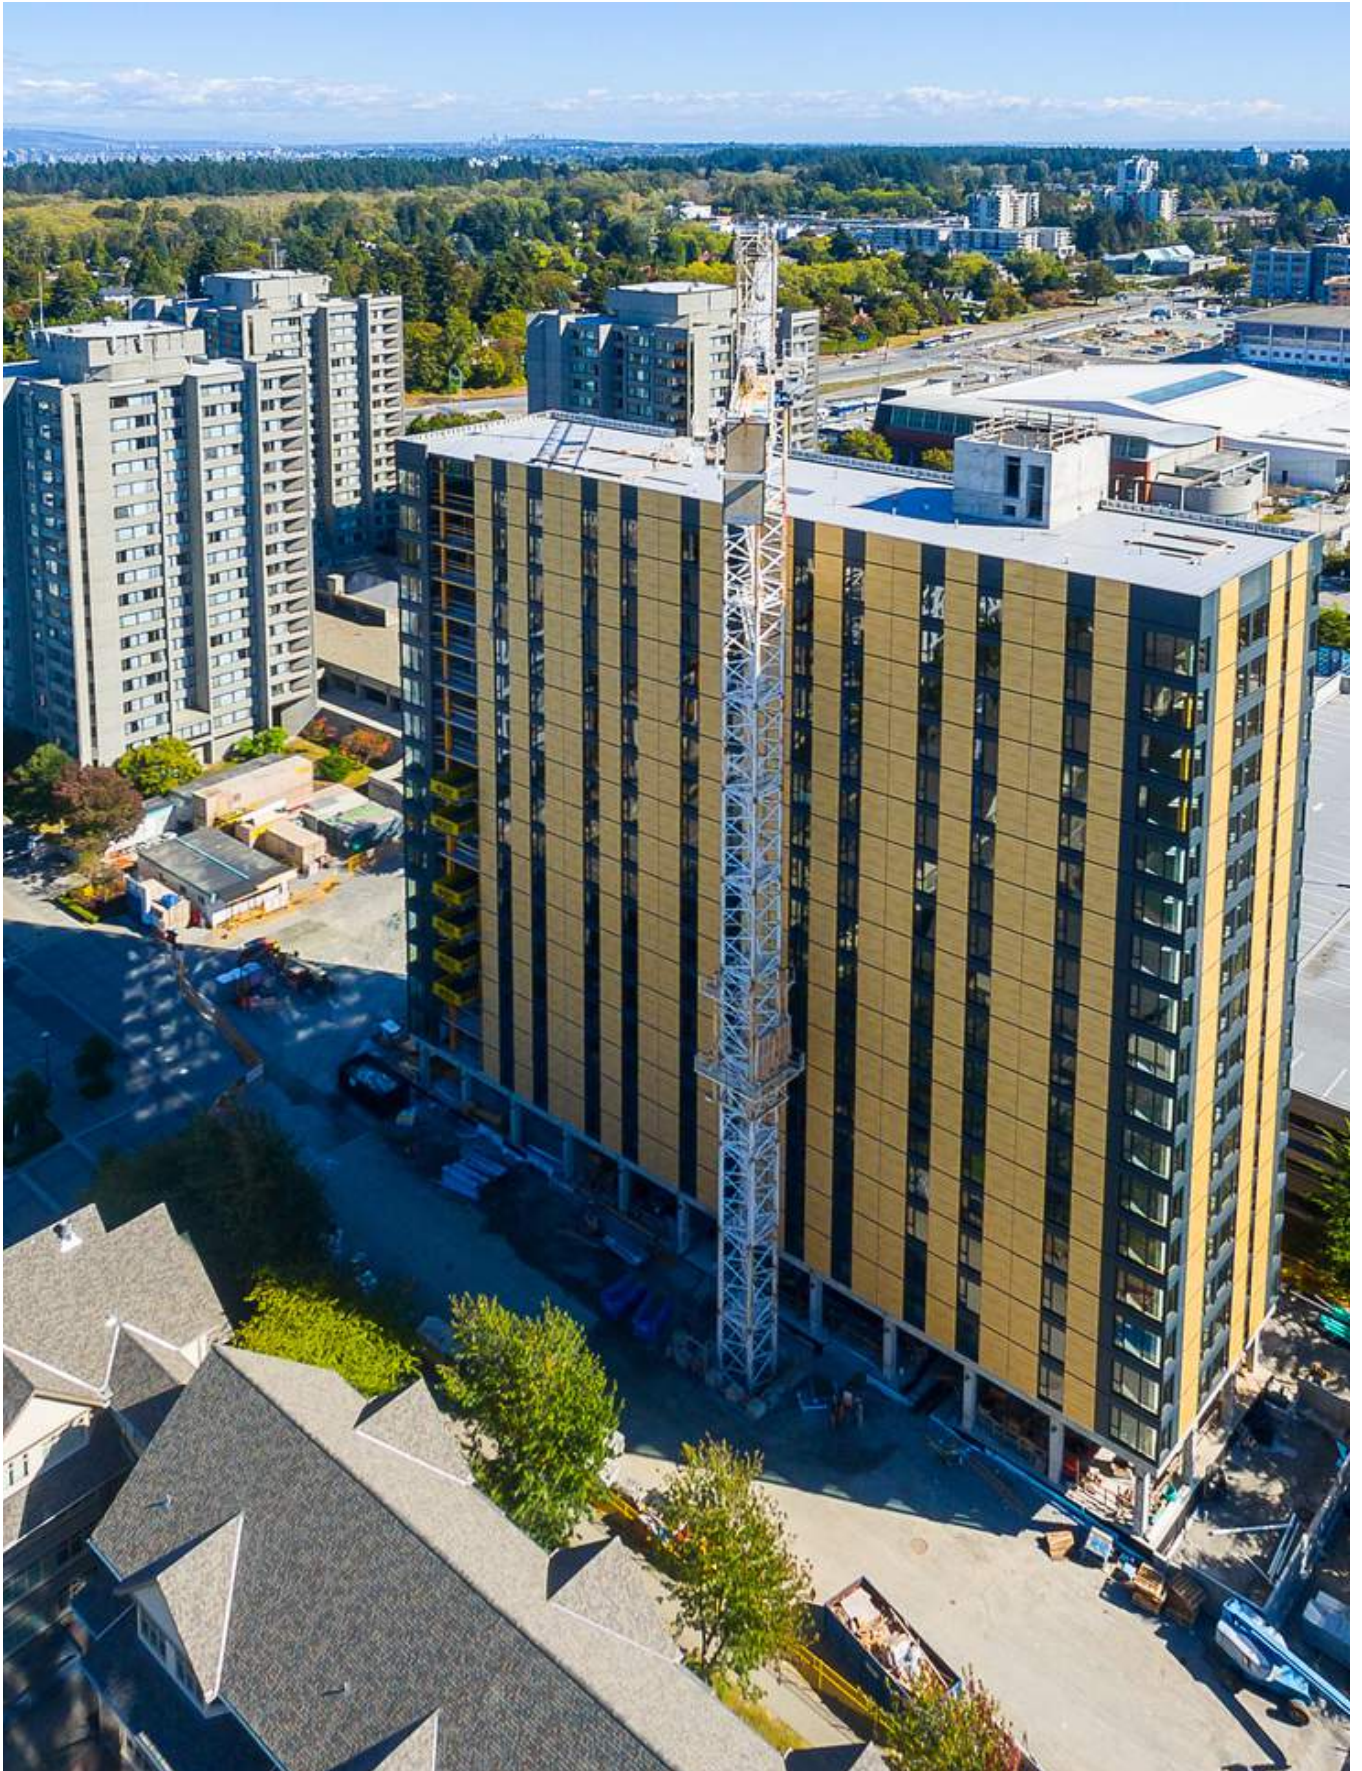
Foto proyecto Brock Commons, British Columbia, Canadá. Fuente: archDaily
